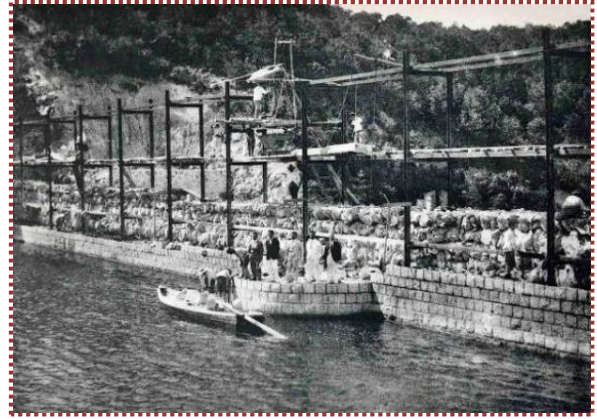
昭和7年9月 補強鉄骨（高さ30尺、幅6尺）施工状況
